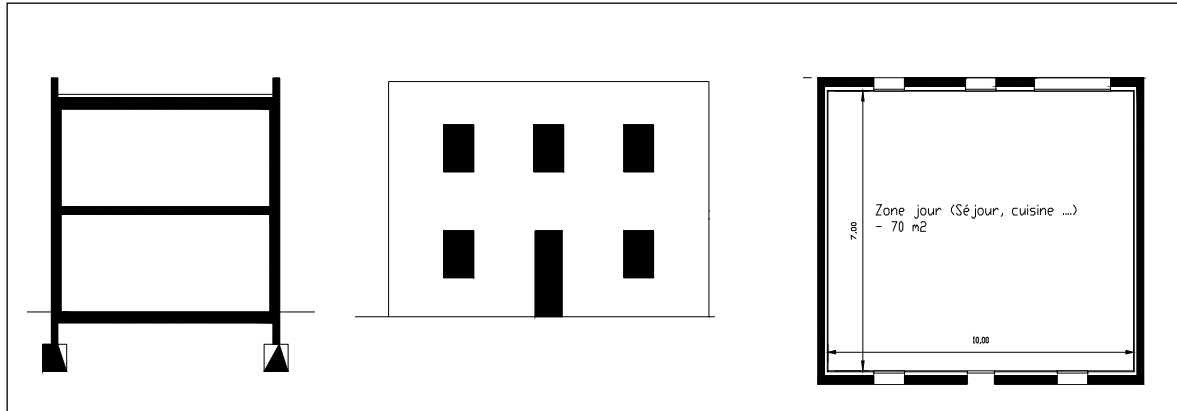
Coupe, façade ouest et plan du rez-de-chaussée.
